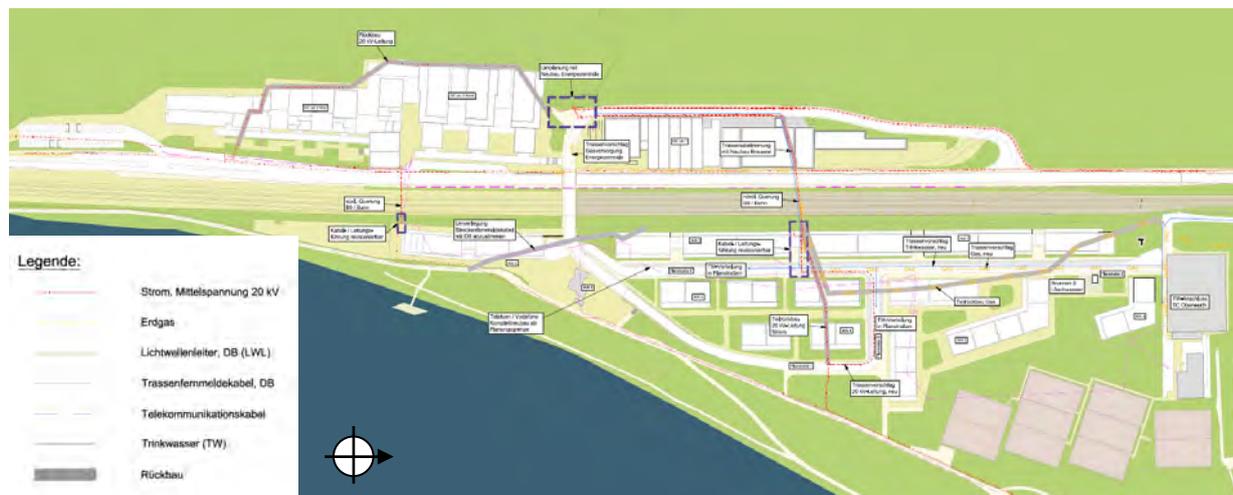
Lageplan Infrastruktur: Bestand (Lagekollisionen) und erste Konfliktlösungsvorschläge
